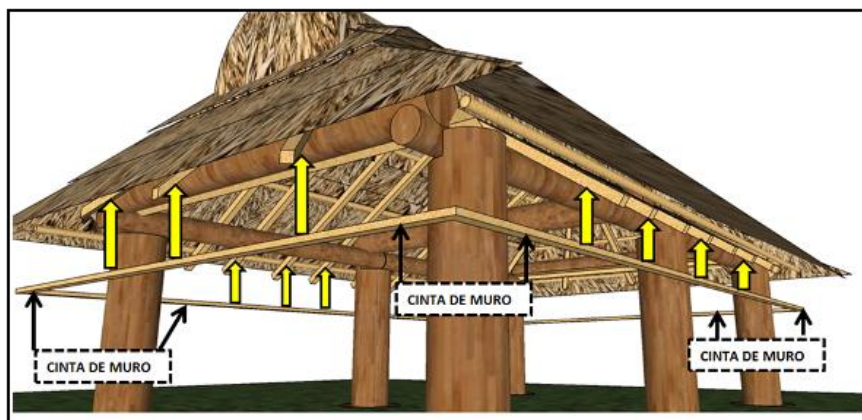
Cinta de muro. Fuente: Cuartas (2013).
